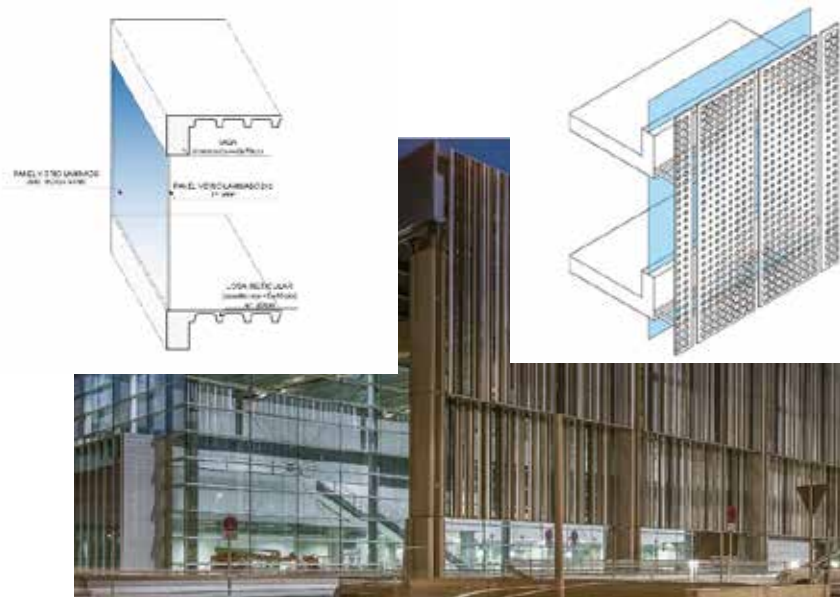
Panel de vidrio laminado y Sistema de doble fachada.
